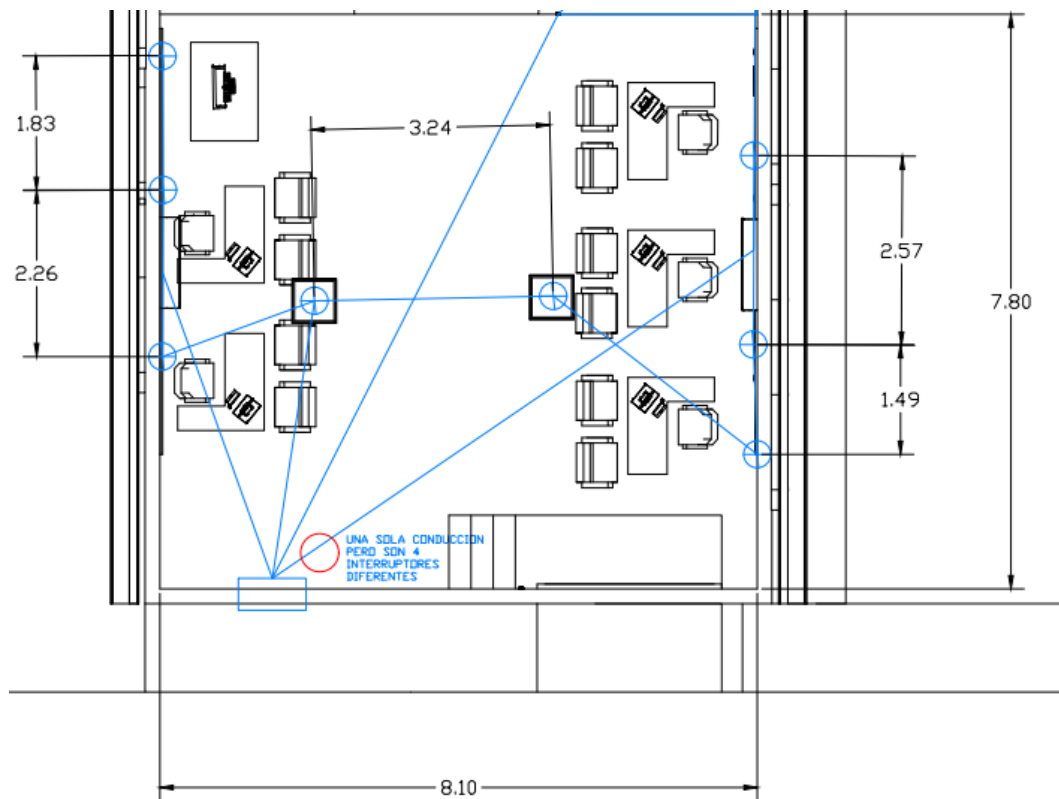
Plano arquitectónico en planta con trazado eléctrico de las oficinas.
